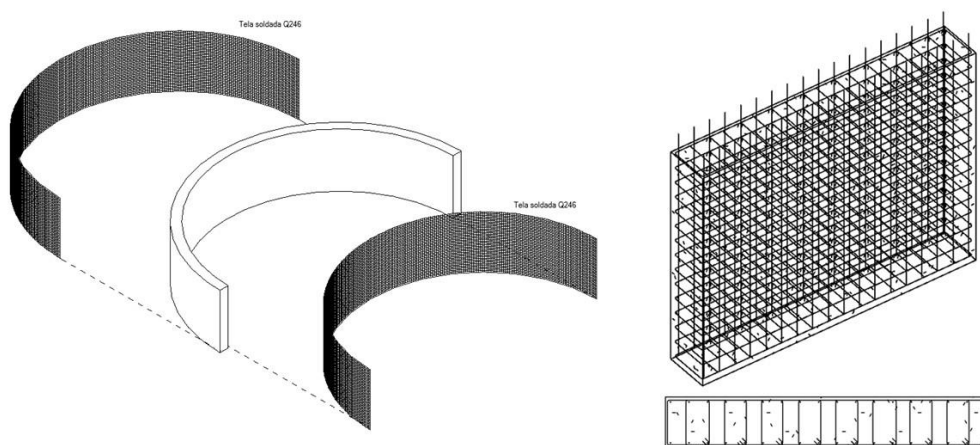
Detalhe de armaduras das paredes externas e internas no Revit
